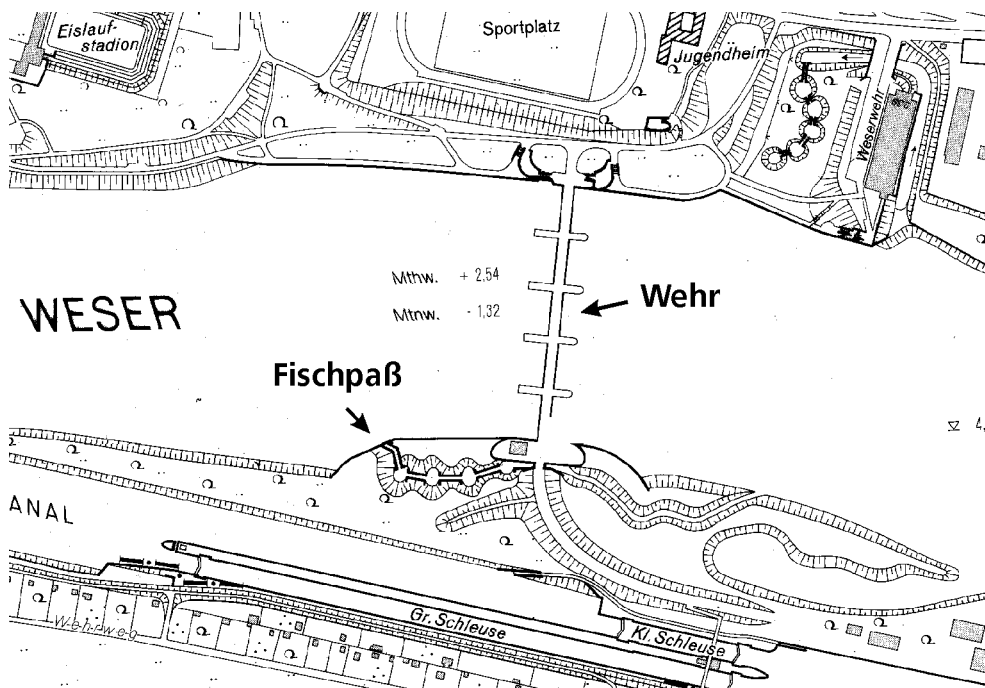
Lageplan der Wehranlage Bremen-Hemelingen
